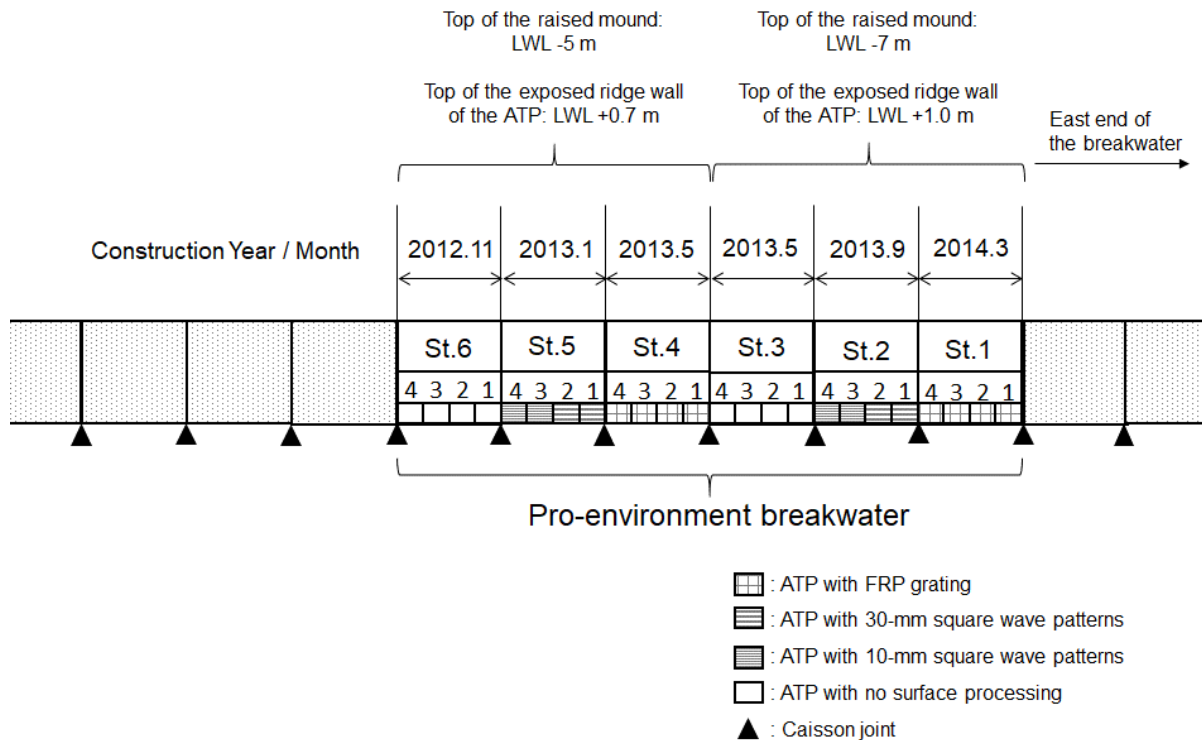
浦添第一防波堤の生物共生型防波堤の施工状況と各ケーソン，ATP の名称
